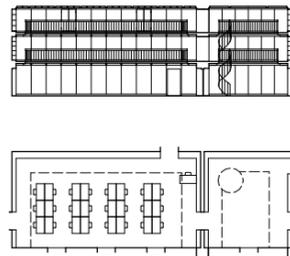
Grundriss und Schnitt des Lesesaals der
